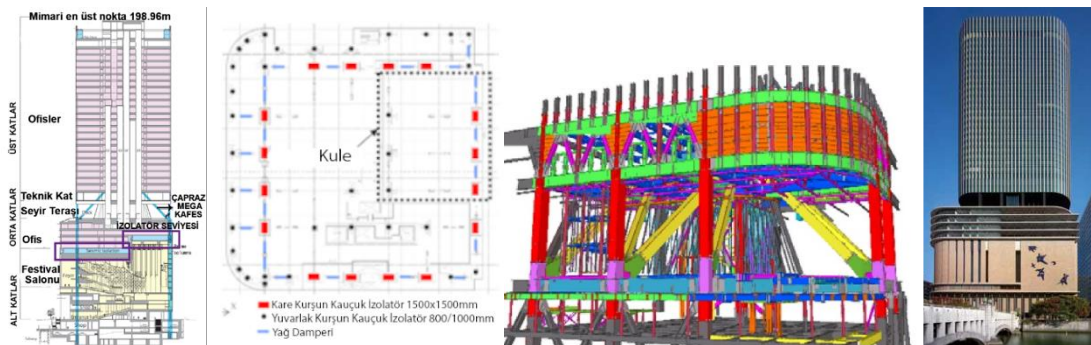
Thousand Tower binası plan, kesit ve fotoğrafı (Komuro vd., 2005)
